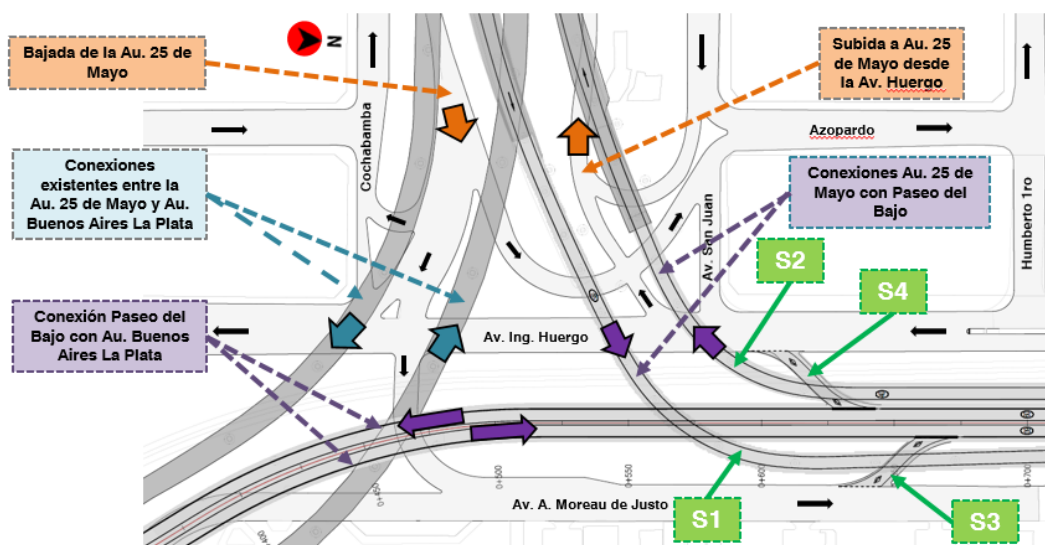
Distribuidor Sur en detalle en el acceso a Paseo del Bajo
